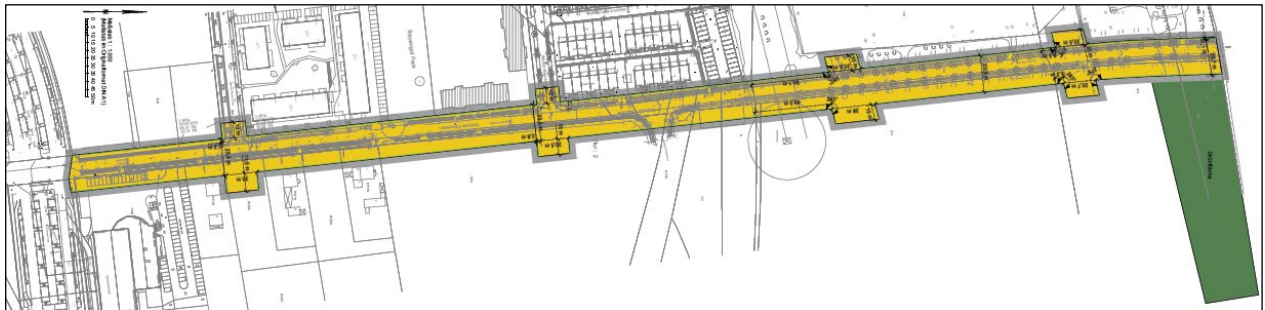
Ausschnitt Bebauungsplan 11/18 „Rudower Chaussee“ Variante B; Stand: 11.10.2021 [U 2]
